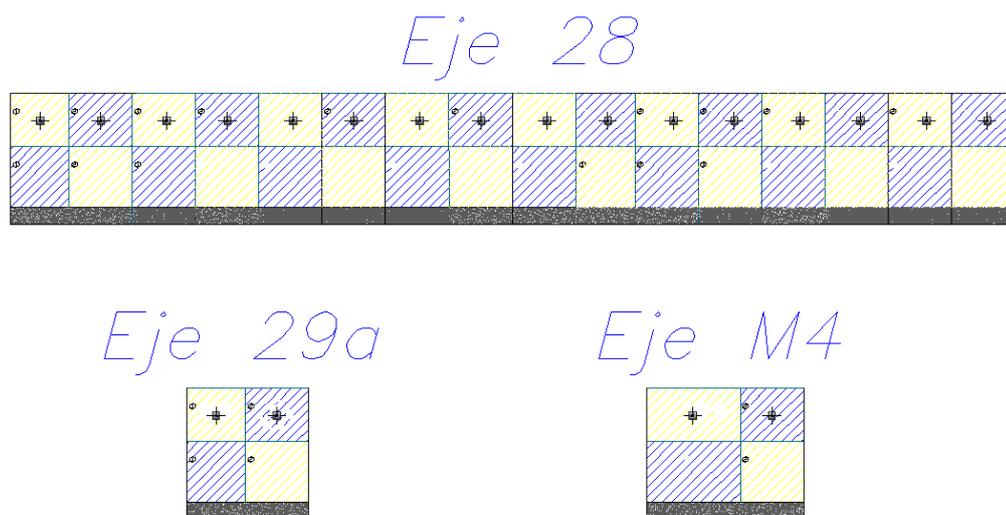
Sectorizaci3n de Muros Pantalla. Fuente: Elaboraci3n Propia
